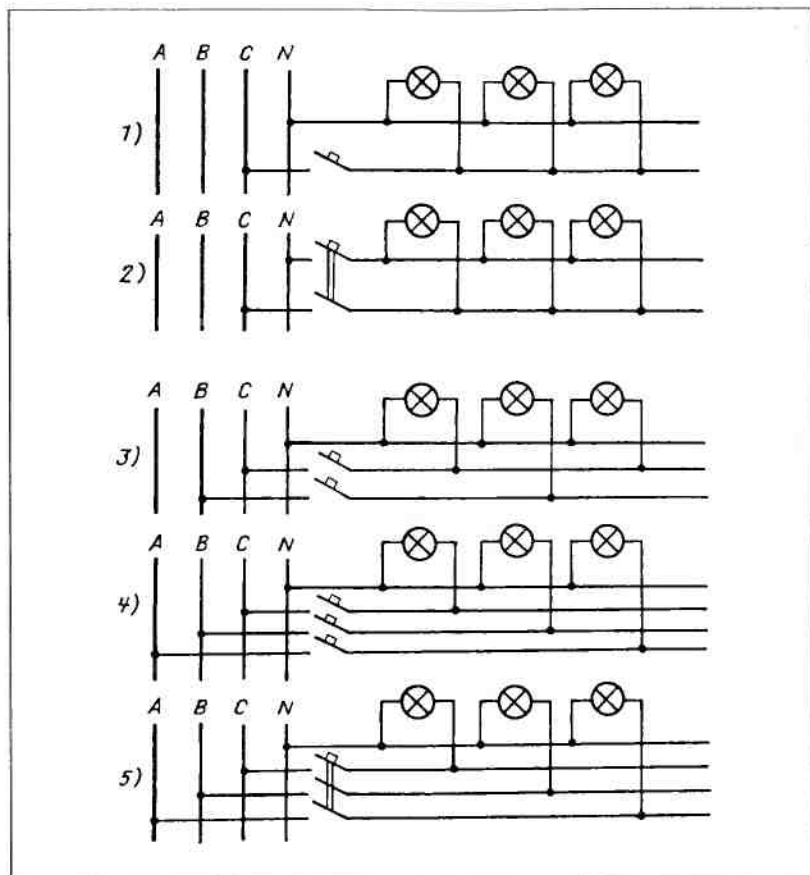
Схемы групповых линий при трехфазной системе с нулевым проводом: 1 — двухпроводная; 2 — двухпроводная для взрывоопасных помещений класса В-1; 3 — трехпроводная; 4 — четырехпроводная, защищаемая однополюсными автоматическими выключателями; 5 — четырехпроводная, защищаемая трехполюсным автоматическим выключателем
